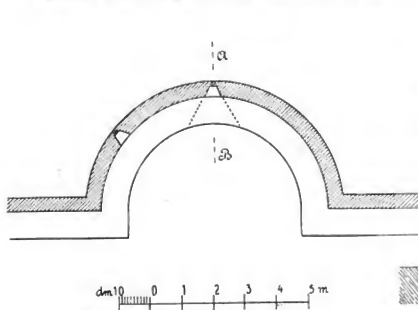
Rokytzan. Grundriss der Bastei.
